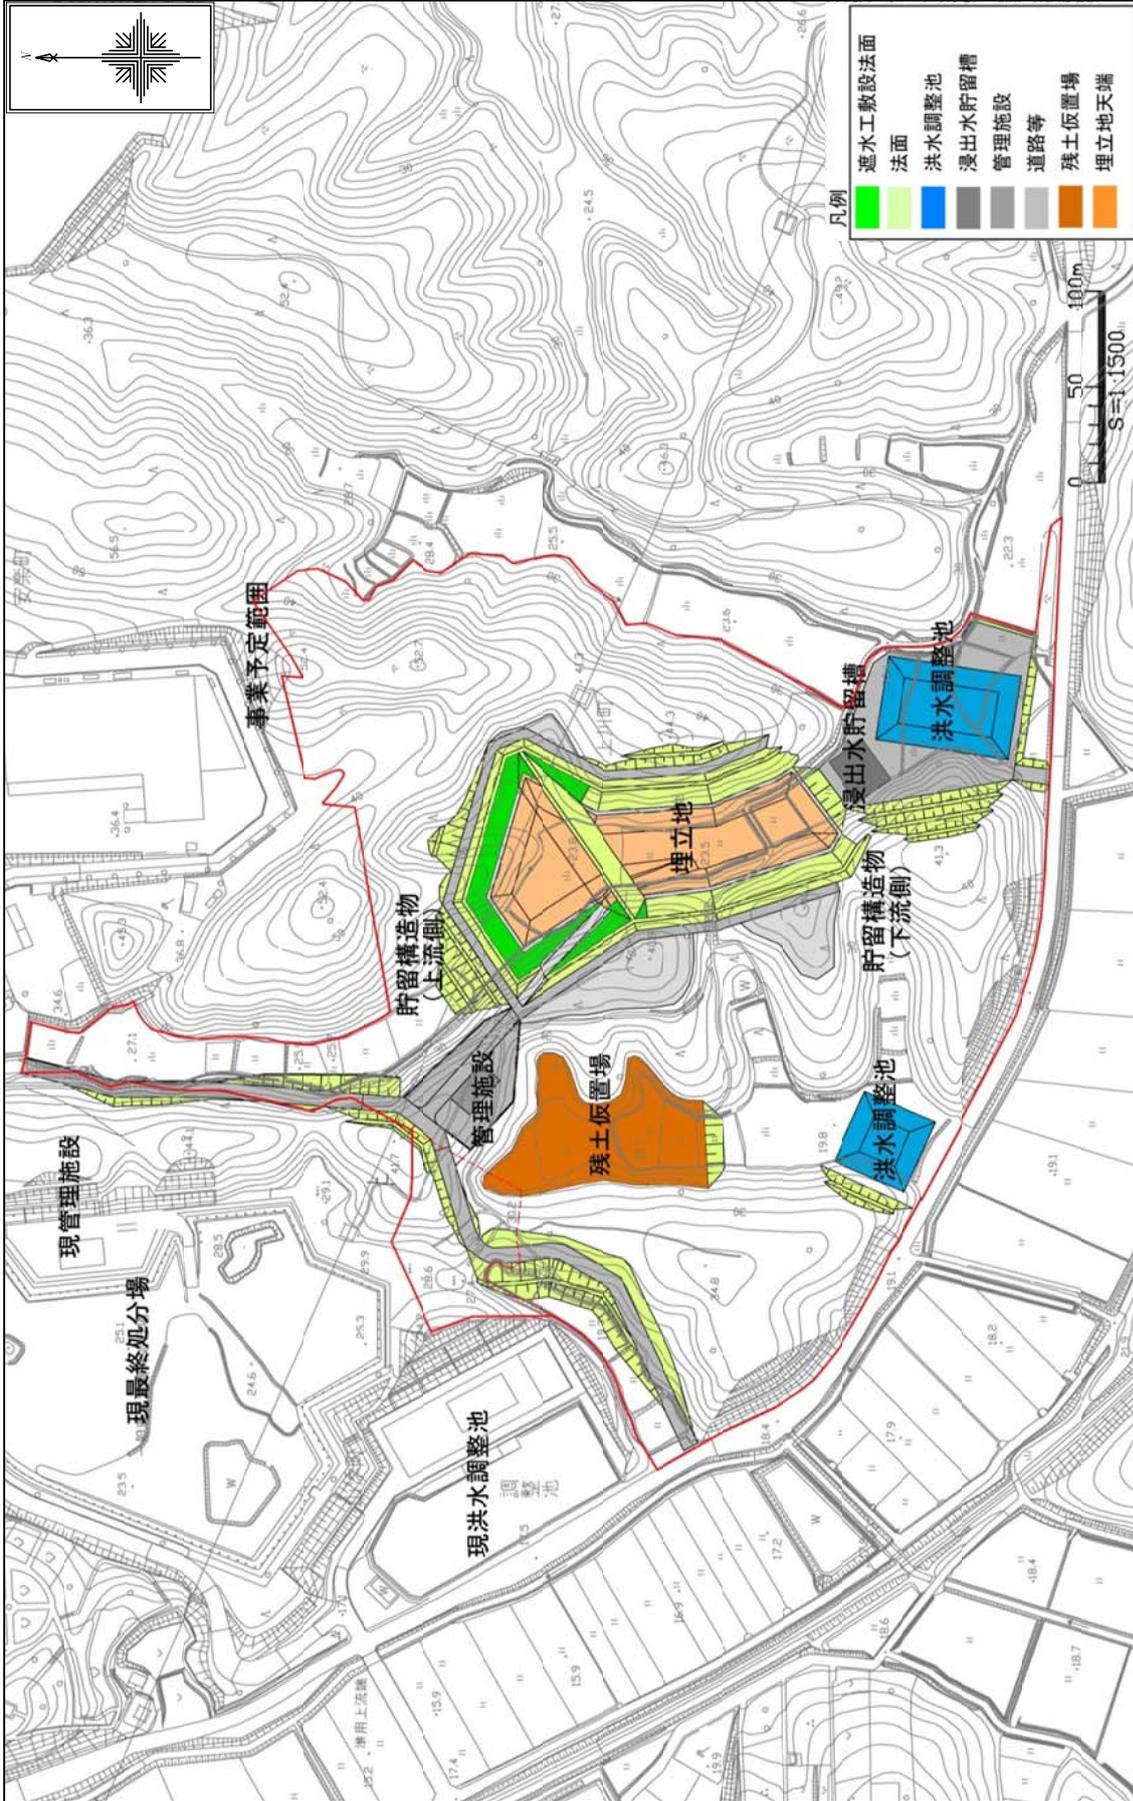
新最終処分場配置平面图 (第 2 期)
